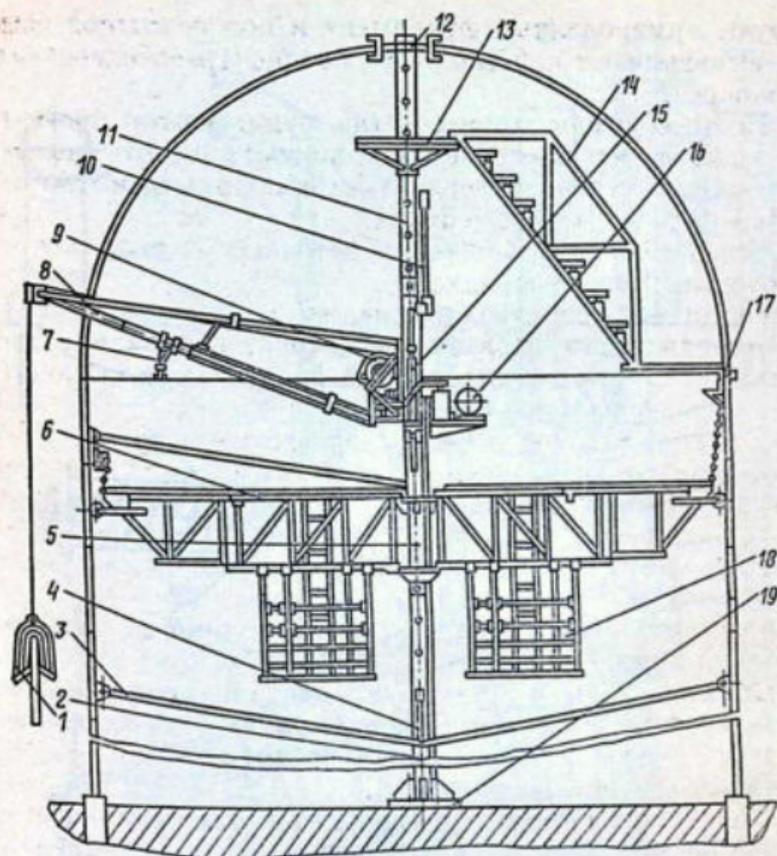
Установка для монтажа сенажных башен ОПТ-8730:
